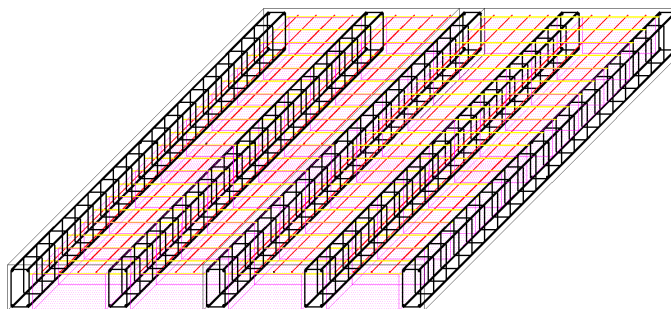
Схема армирования сборно-моноконтного перекрытия
